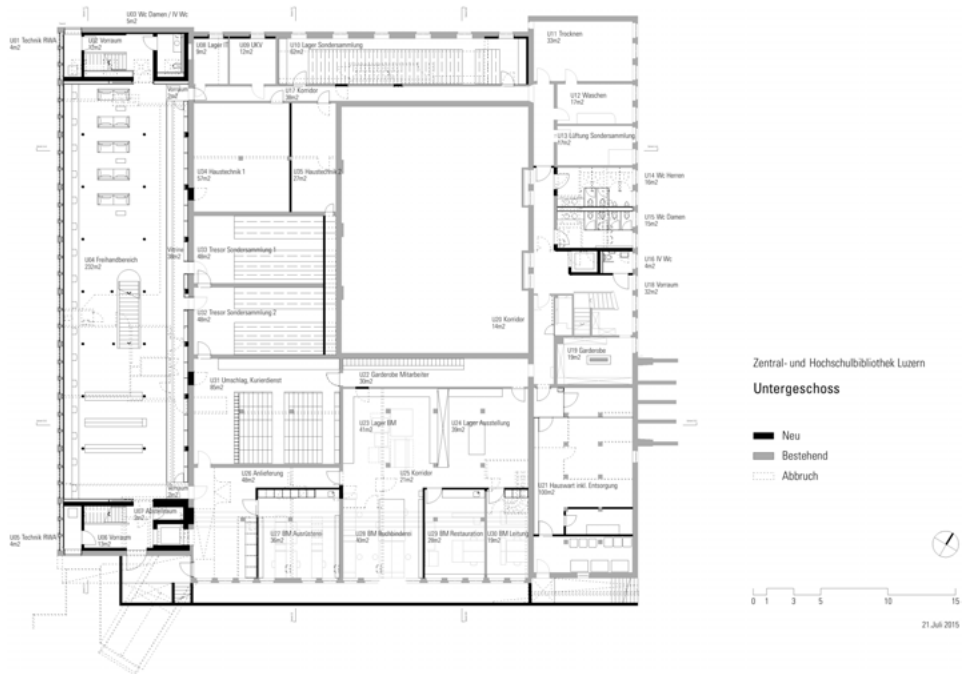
Grundriss des Untergeschosses mit dem Schaufenster der Sondersammlung
